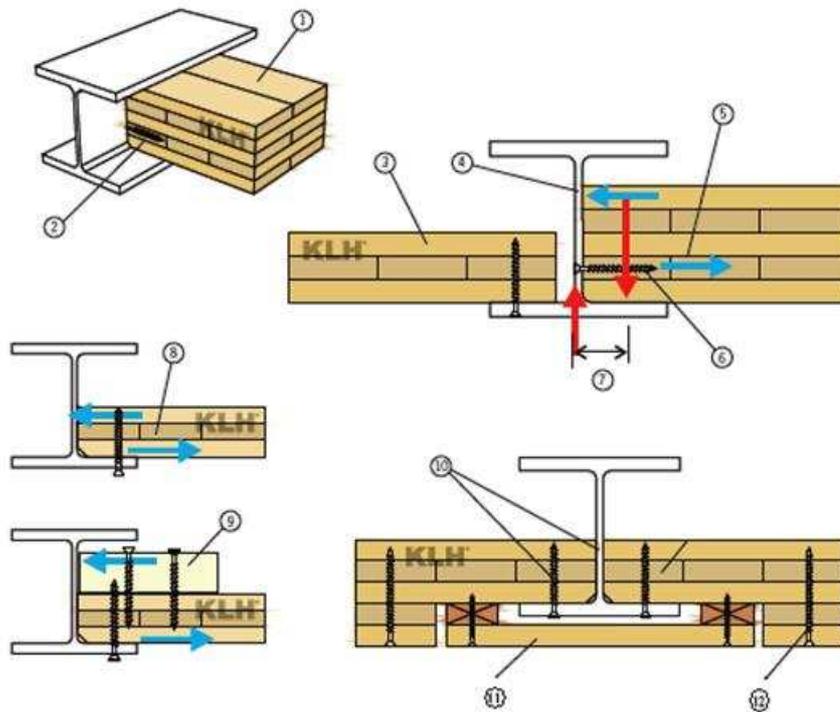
Ligação de painel de laje (teto) com viga de aço [24]
